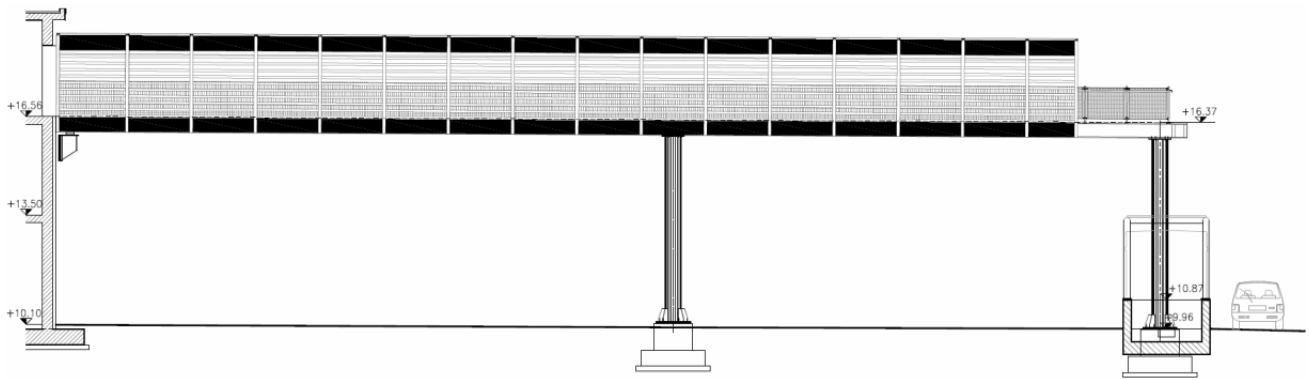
Prospetto della passerella pedonale (estratto dalla tavola I.01.08.0.0).
